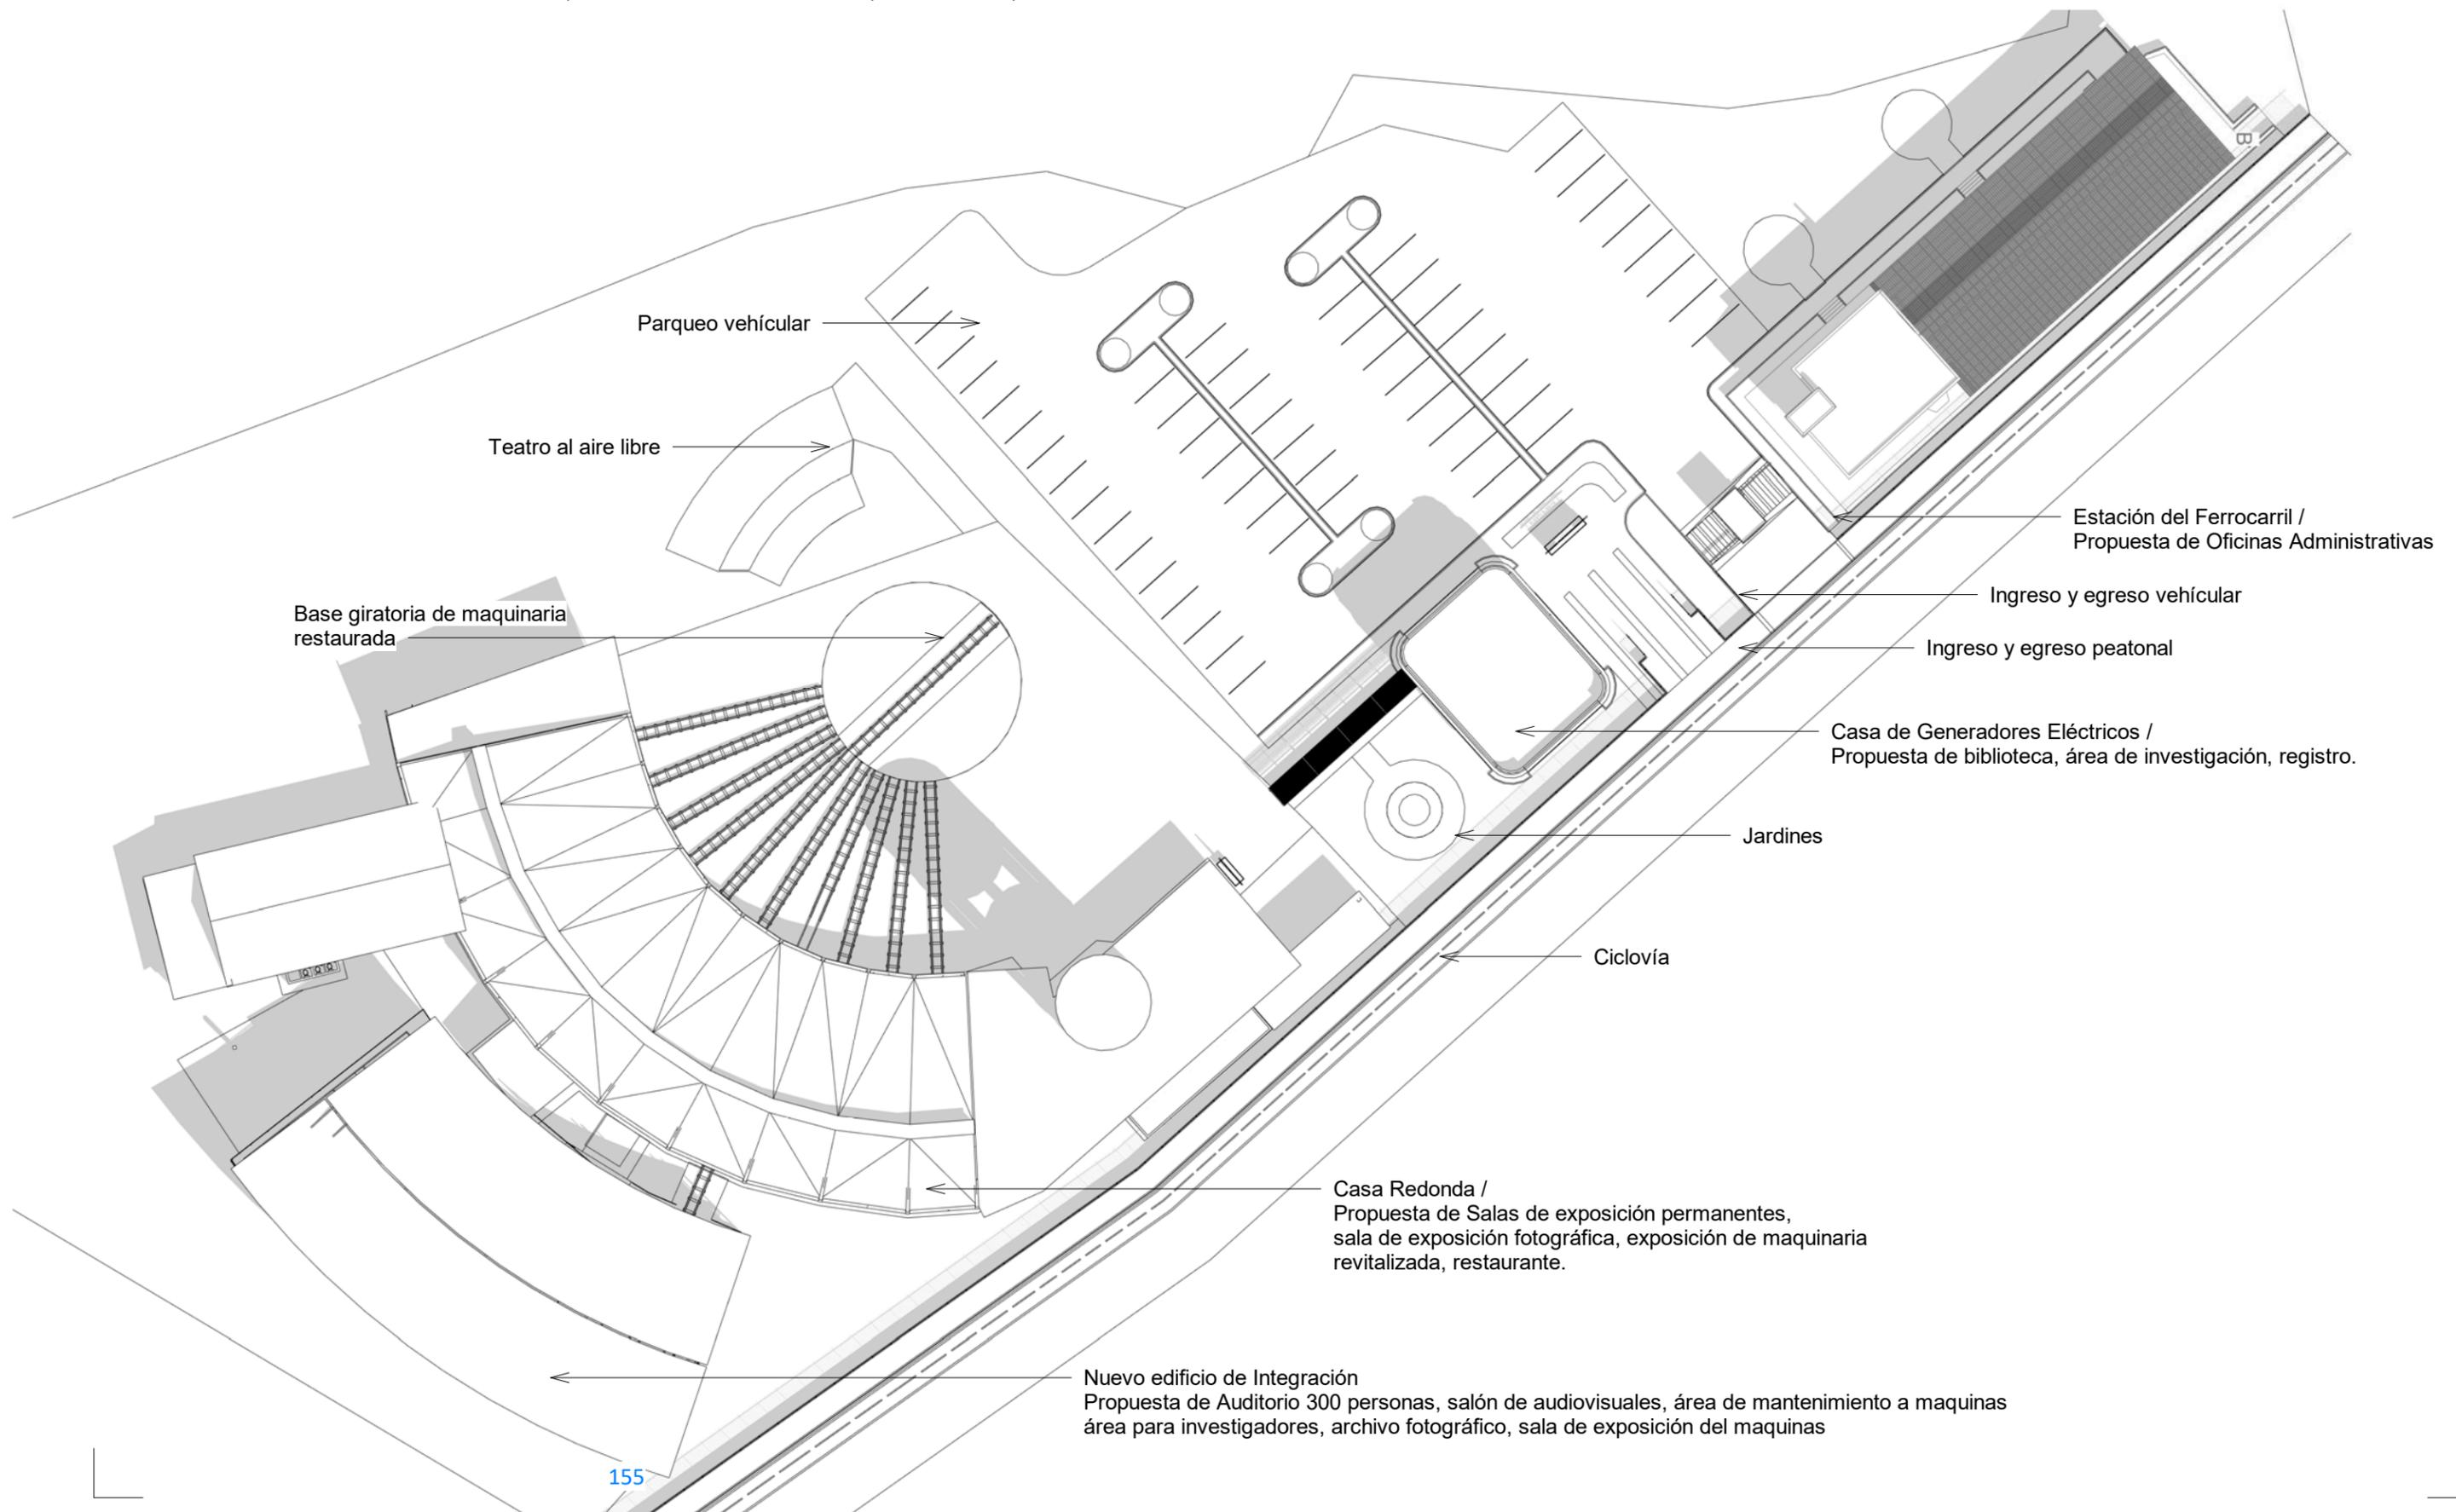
Prefiguración planta de conjunto. Elaboración propia
